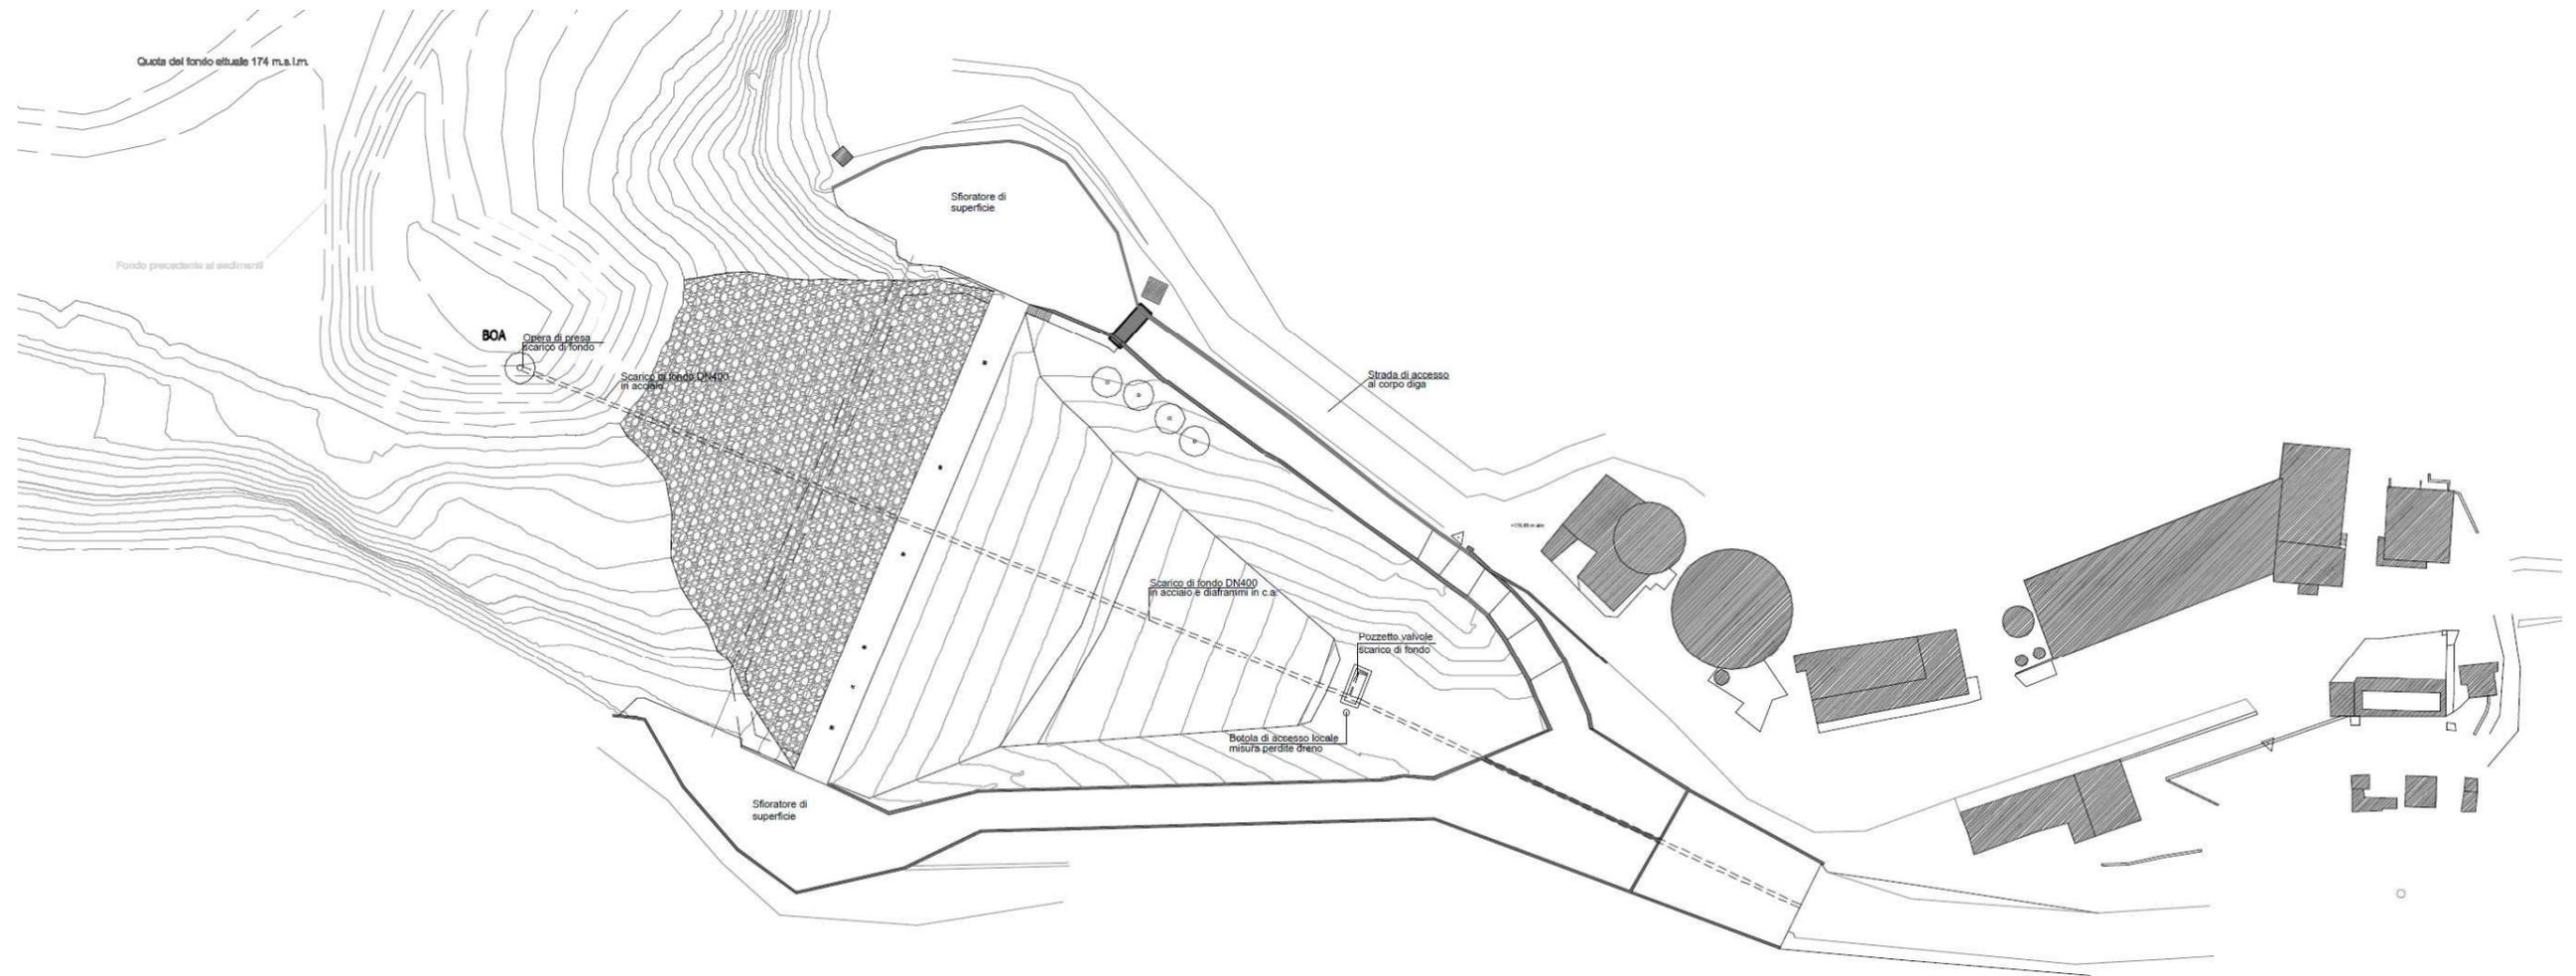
Planimetria della diga Drove di Cepparello allo stato attuale.
